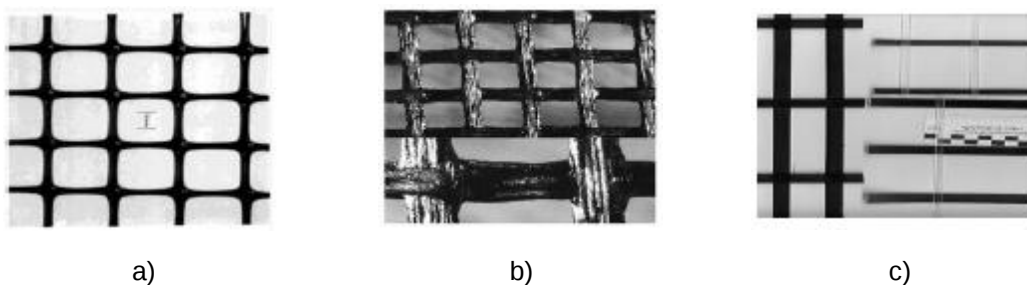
Exemplos de geogrelhas: a) biaxial; b) tecida; c) soldada a laser (Lopes, 1998)
